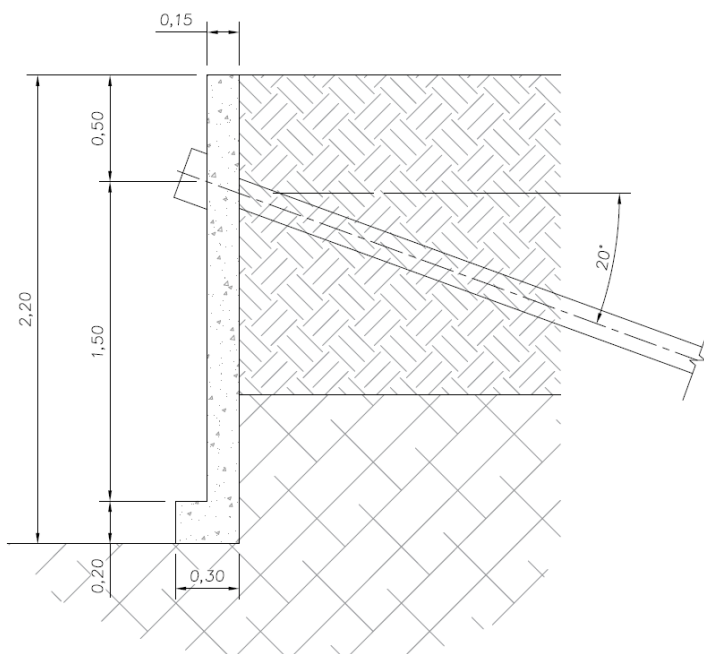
Detalle geométrico del muro de concreto lanzado reforzado y anclado.
